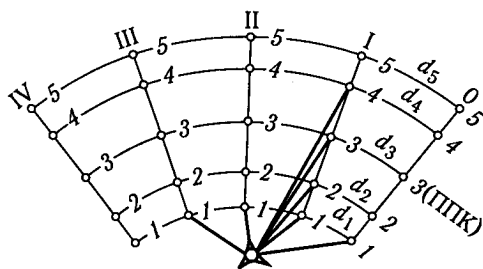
Схема розмічування та вертикального планування віражу на заокругленні
